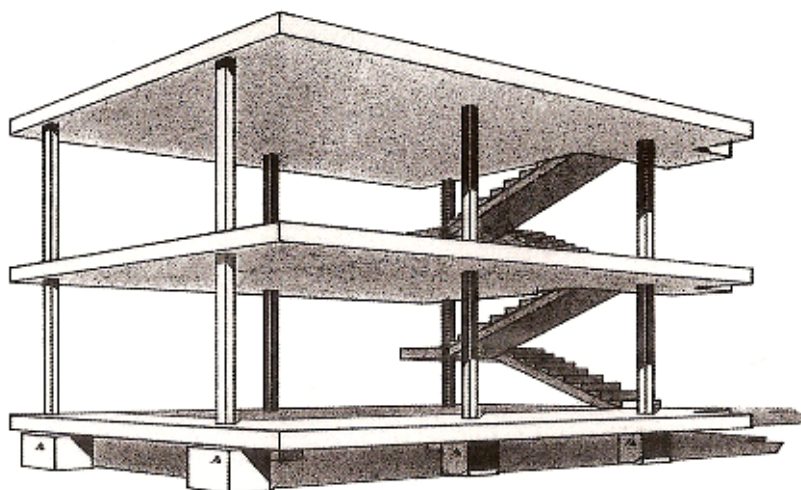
Casa *Dom-ino*: Sistema estrutural de betão reforçado.
